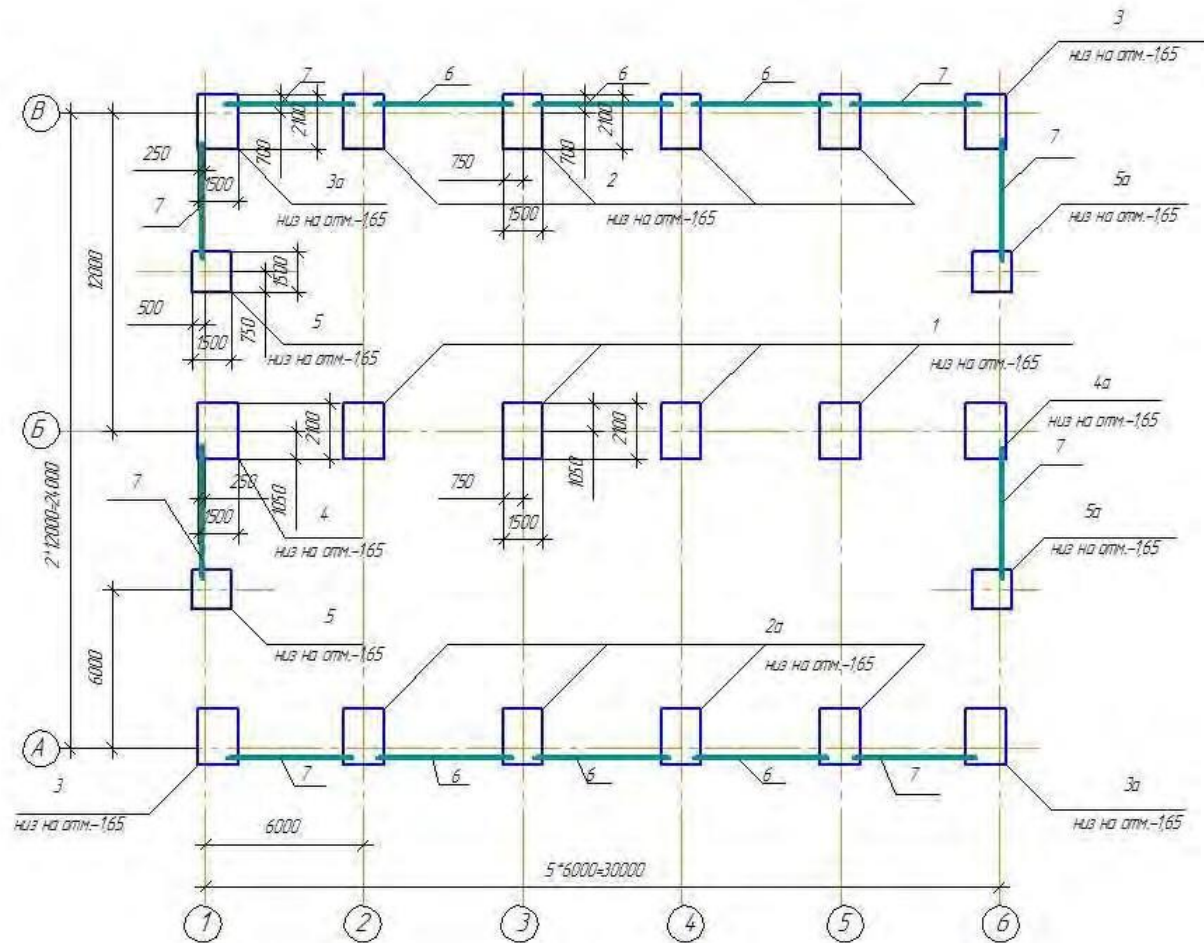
Схема расположения элементов фундаментов и фундаментных балок
